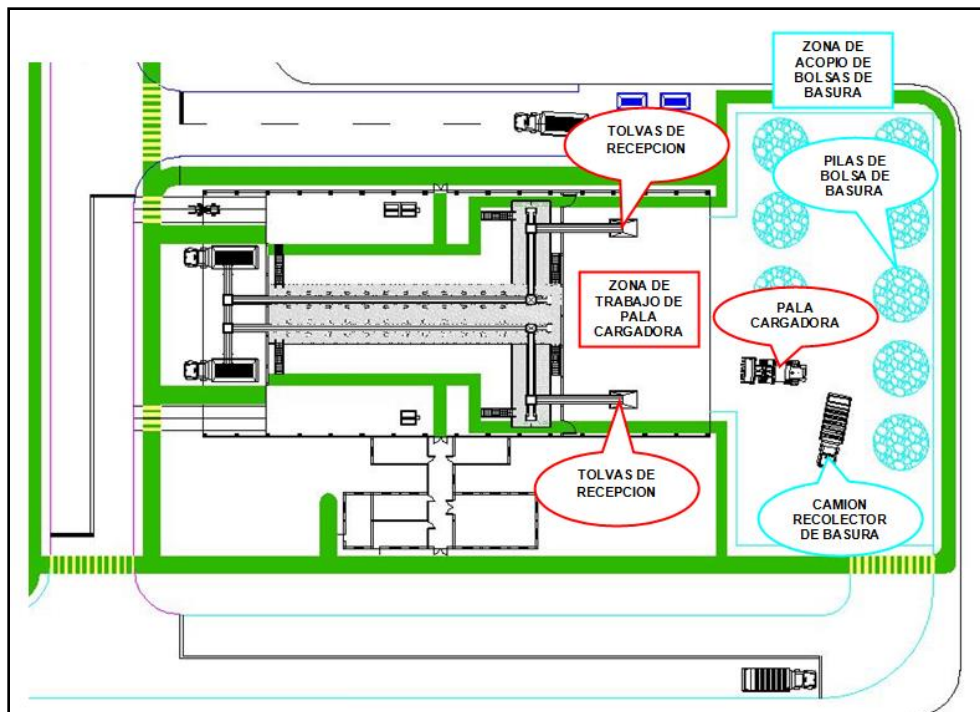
Detalle de la zona de descarga de basura y zona de trabajo de la pala-cargadora.
